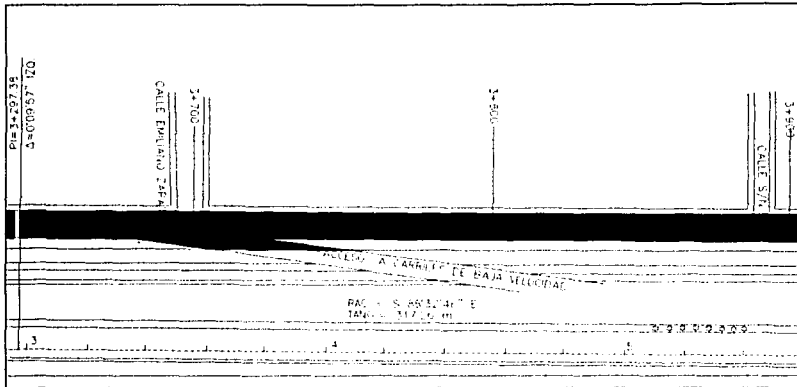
Detalle del plano general de una aguja de desincorporación.
